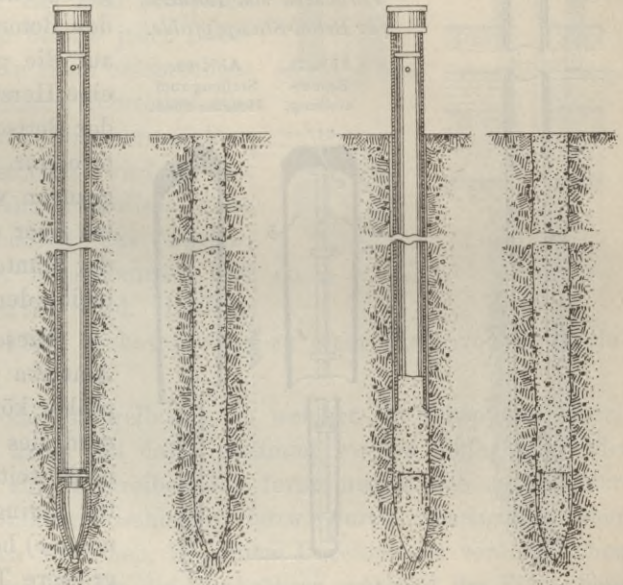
u. 77. Anwendung einer Röhre mit Betonspitze.
